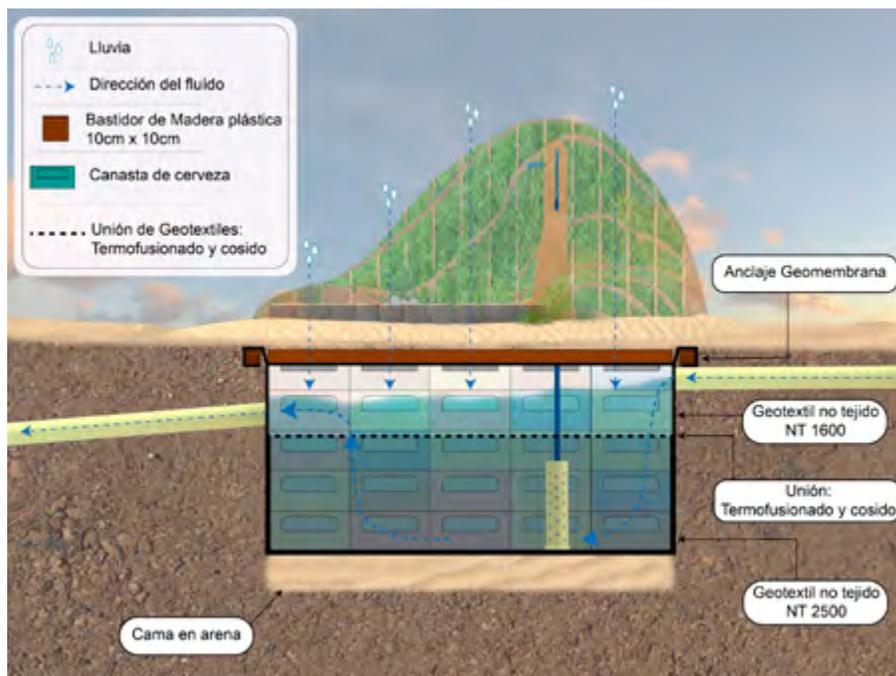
Detalles constructivos del tanque de tormenta, estación 1.
